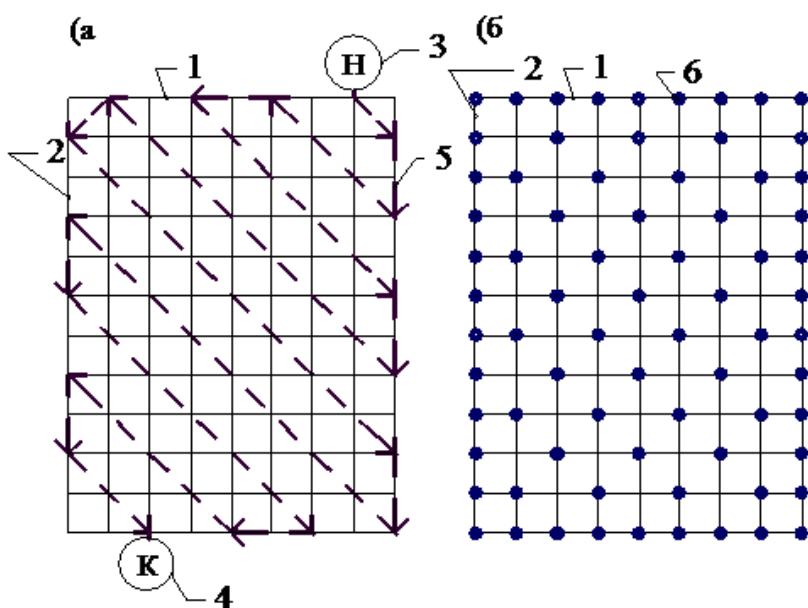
Порядок закріплення арматурних стрижнів в'язальним дротом:
